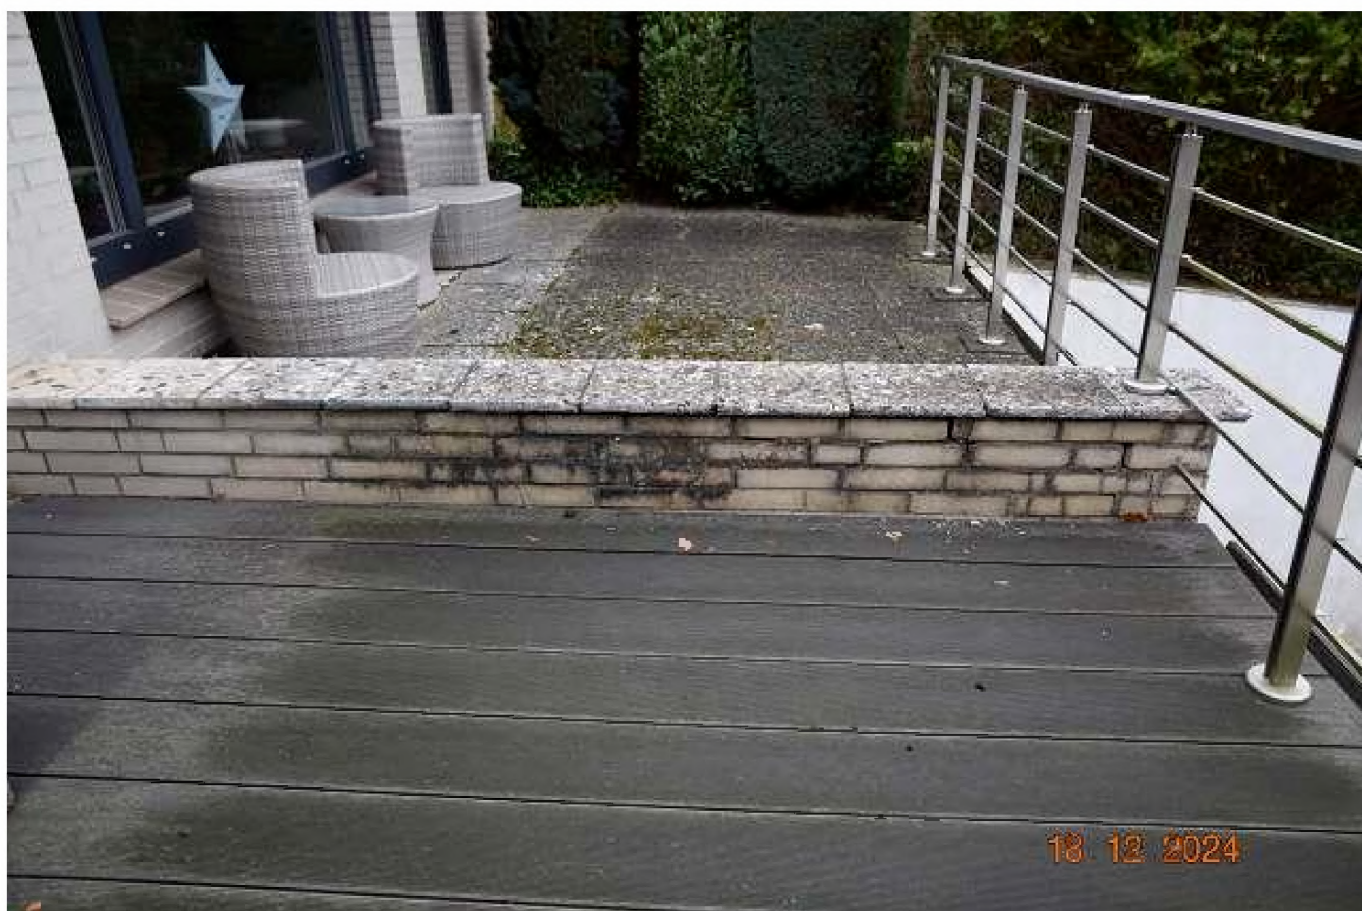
/16 – Übersichtsfoto Trennwand Terrasse
